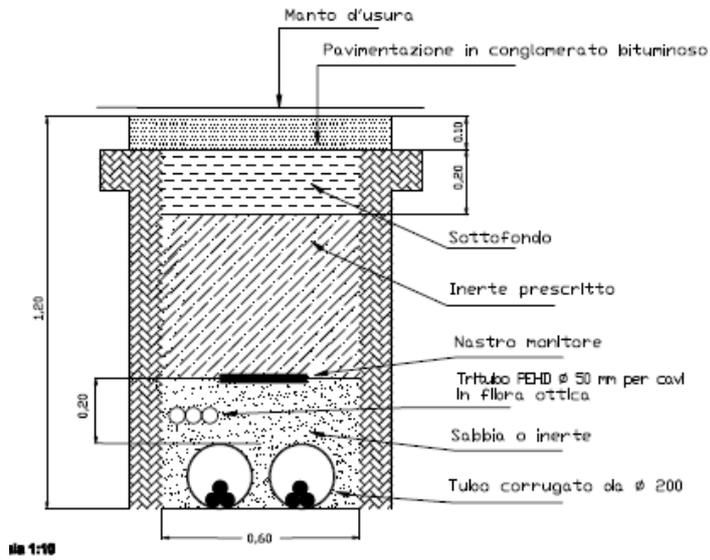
Sezione su strada asfaltata - posa di n°2 cavi MT
